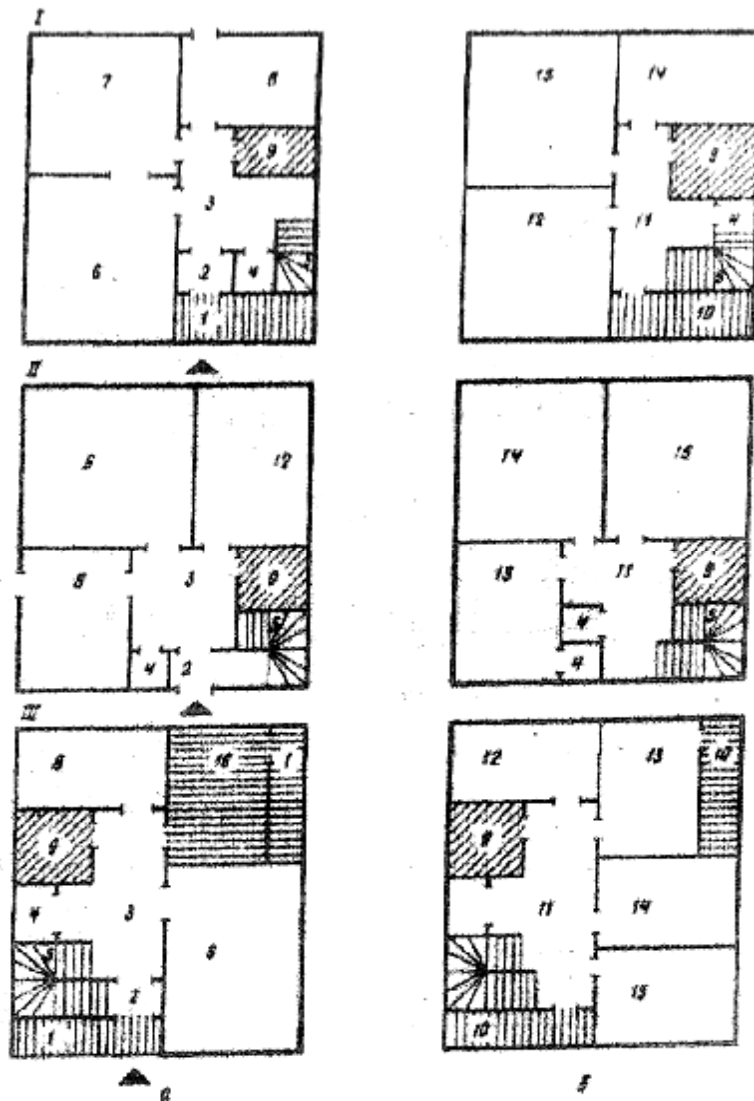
Схеми планування двоповерхових п'ятикімнатних будинків
